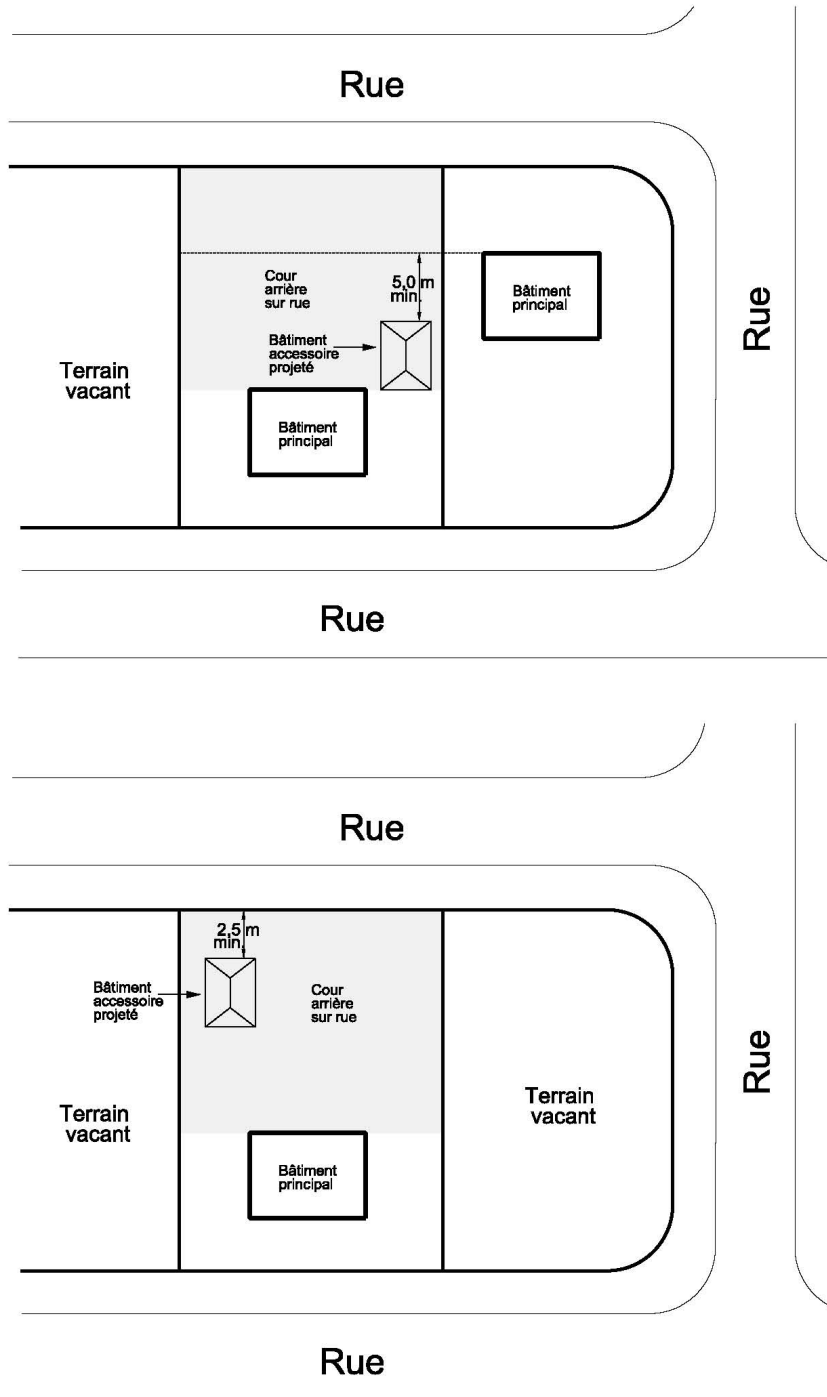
Bâtiment accessoire jumelé en cour arrière sur rue.
